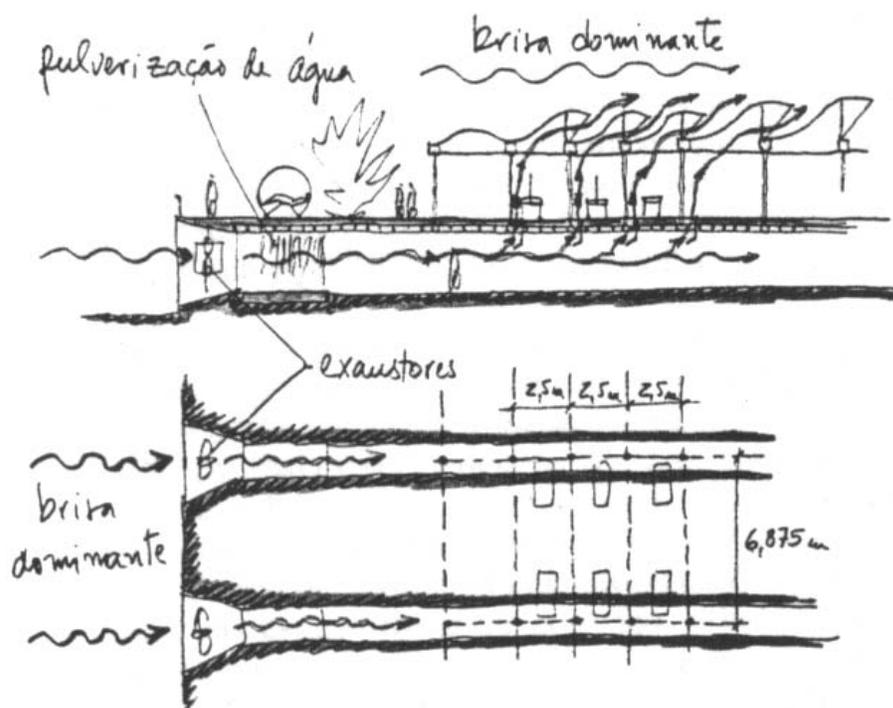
Croquis de Lele do sistema de ventilação do hospital em Salvador.(LATORRACA, 2000)
